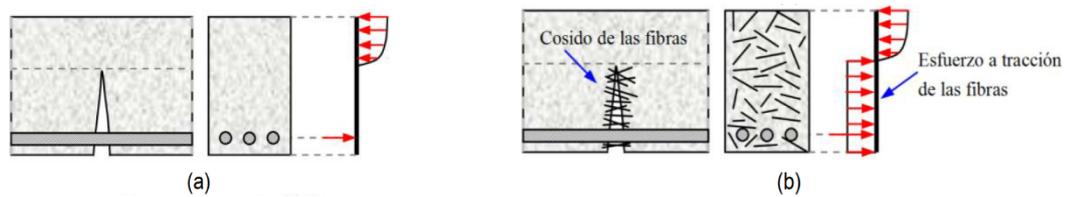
Distribución de tensiones: (a) Concreto armado sin fibras de acero, (b) Concreto armado reforzado con fibras de acero.
